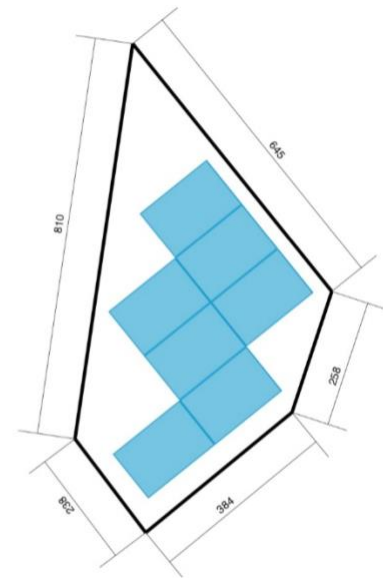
Schulhausstrasse 3, Belegungsplan, Dachfläche 1
